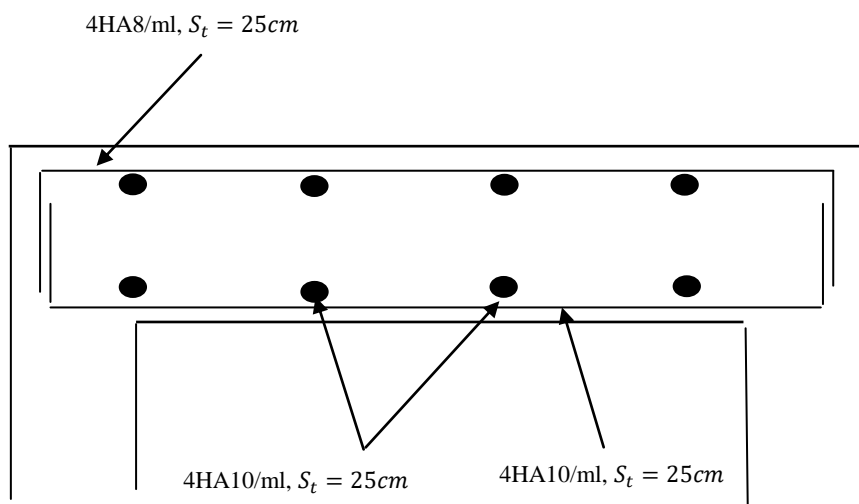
3: plan de ferrailage de la salle machine suivant x – x et y – y
